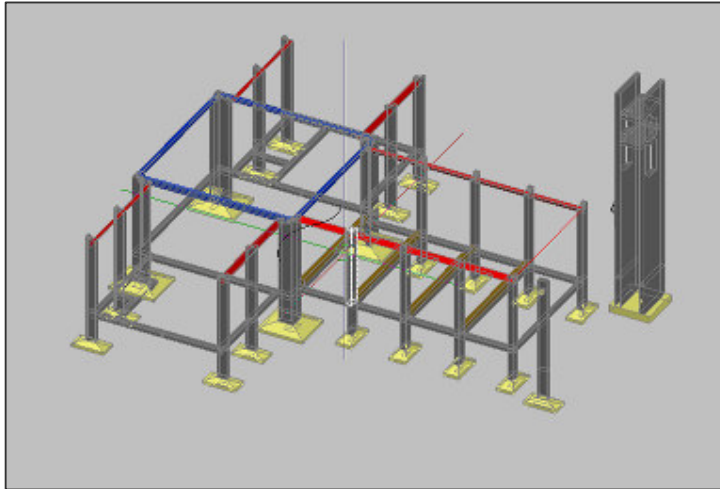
5 Fundación , Vigas , Tabiques y Vigas de Borde.
